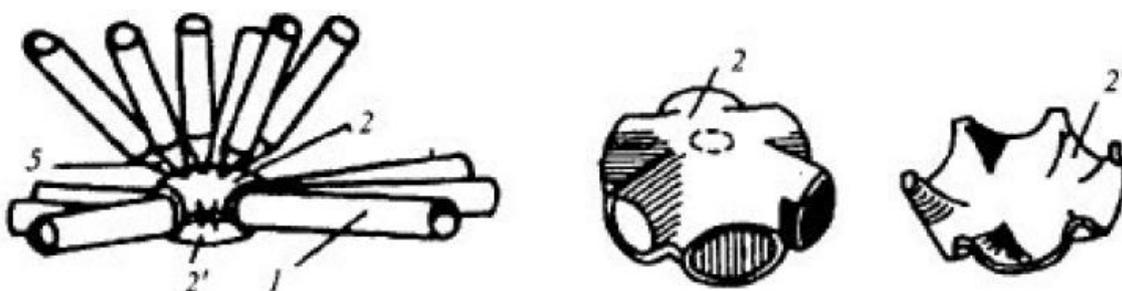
Узел «SDC»: 1 – стержни пояса; 2 – нижняя узловая деталь; 2' – верхняя узловая деталь; 3 – раскосы
